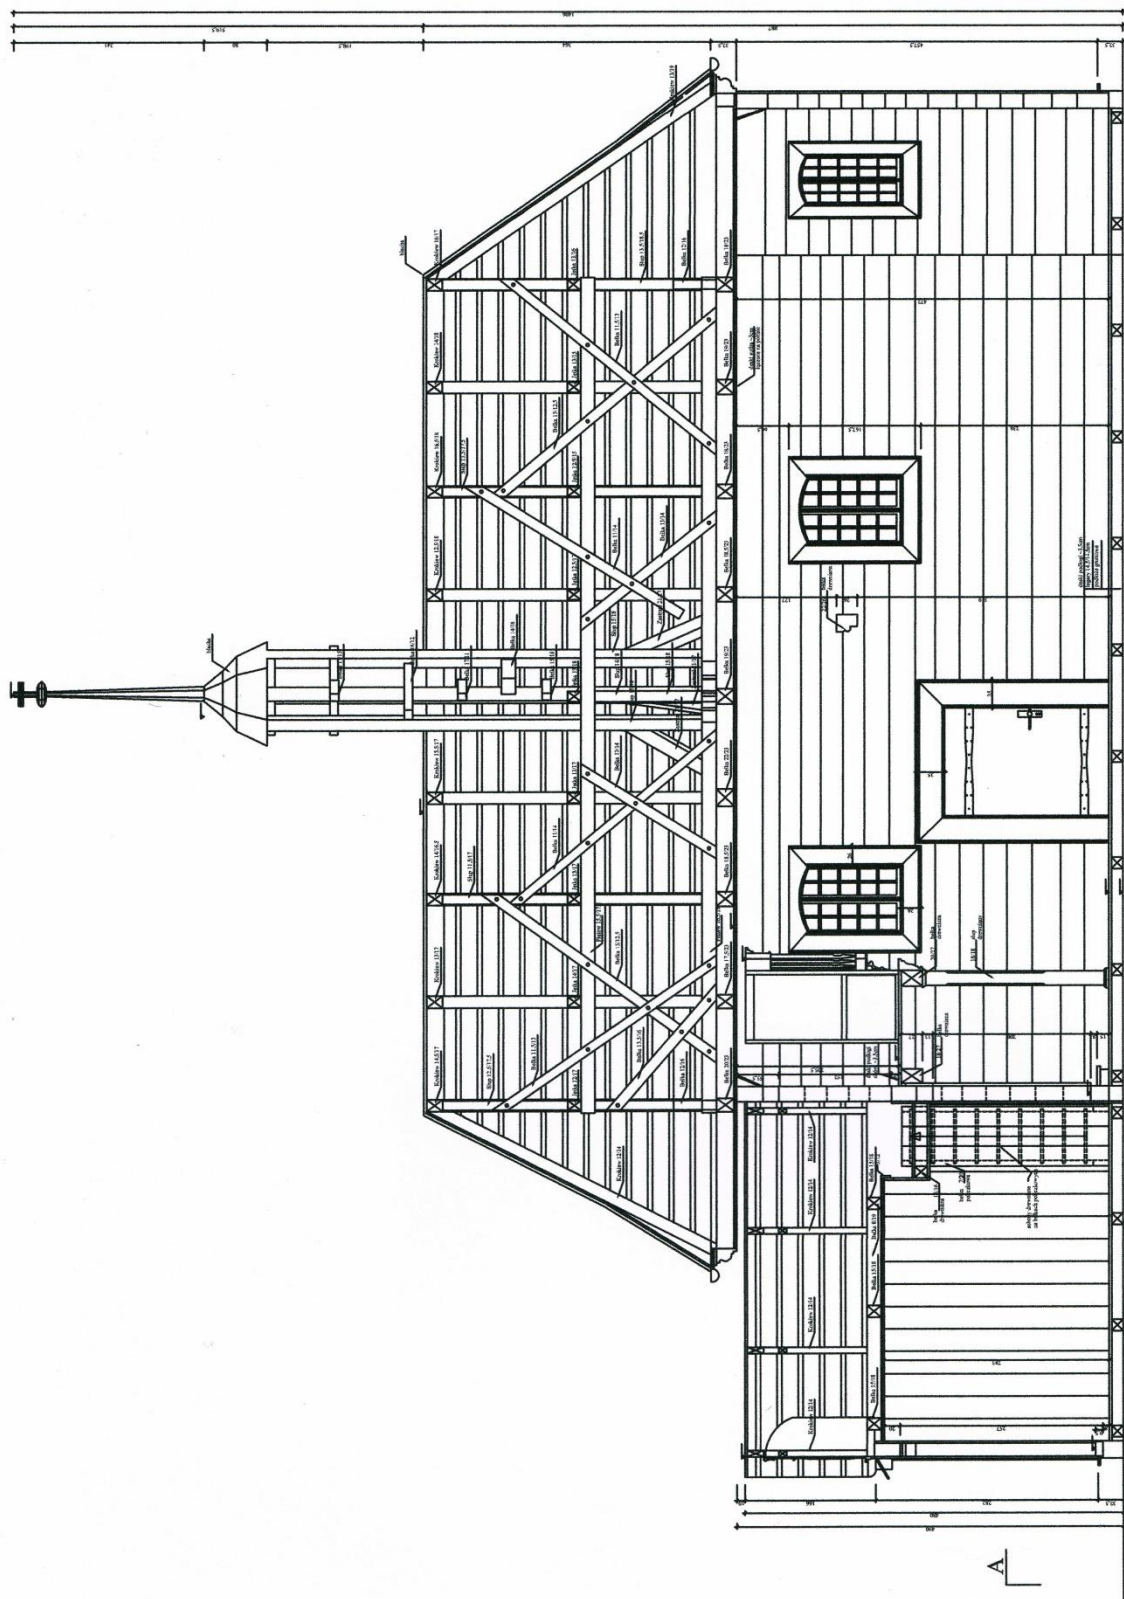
Rzut wieży dachowej z oznaczeniem osi
